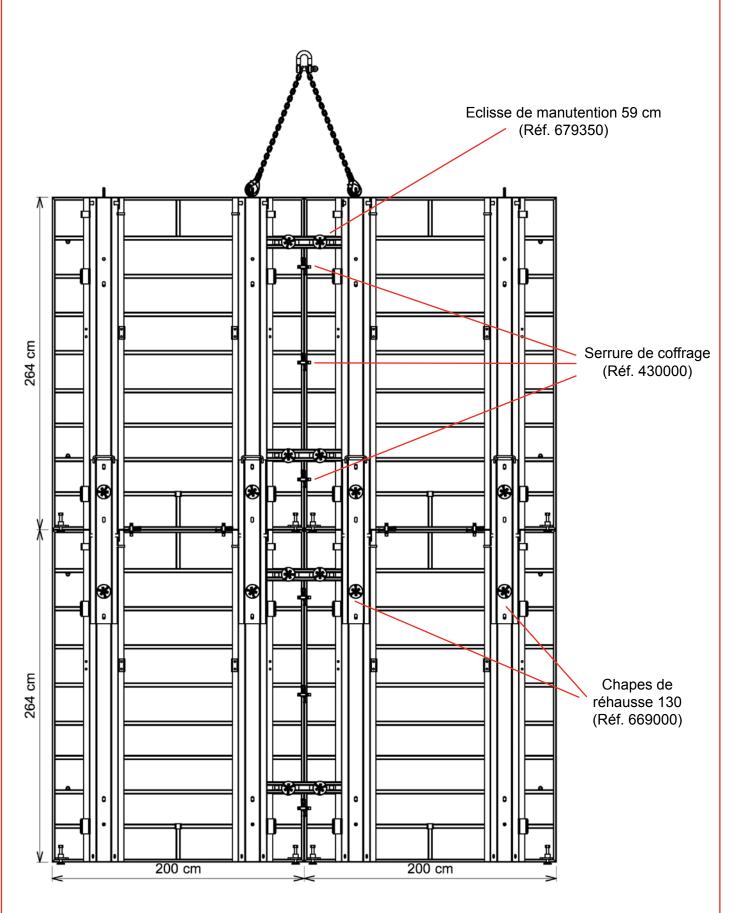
Préhension d'un train de banche élingage sur les anneaux et rigidification des banches entre elles
